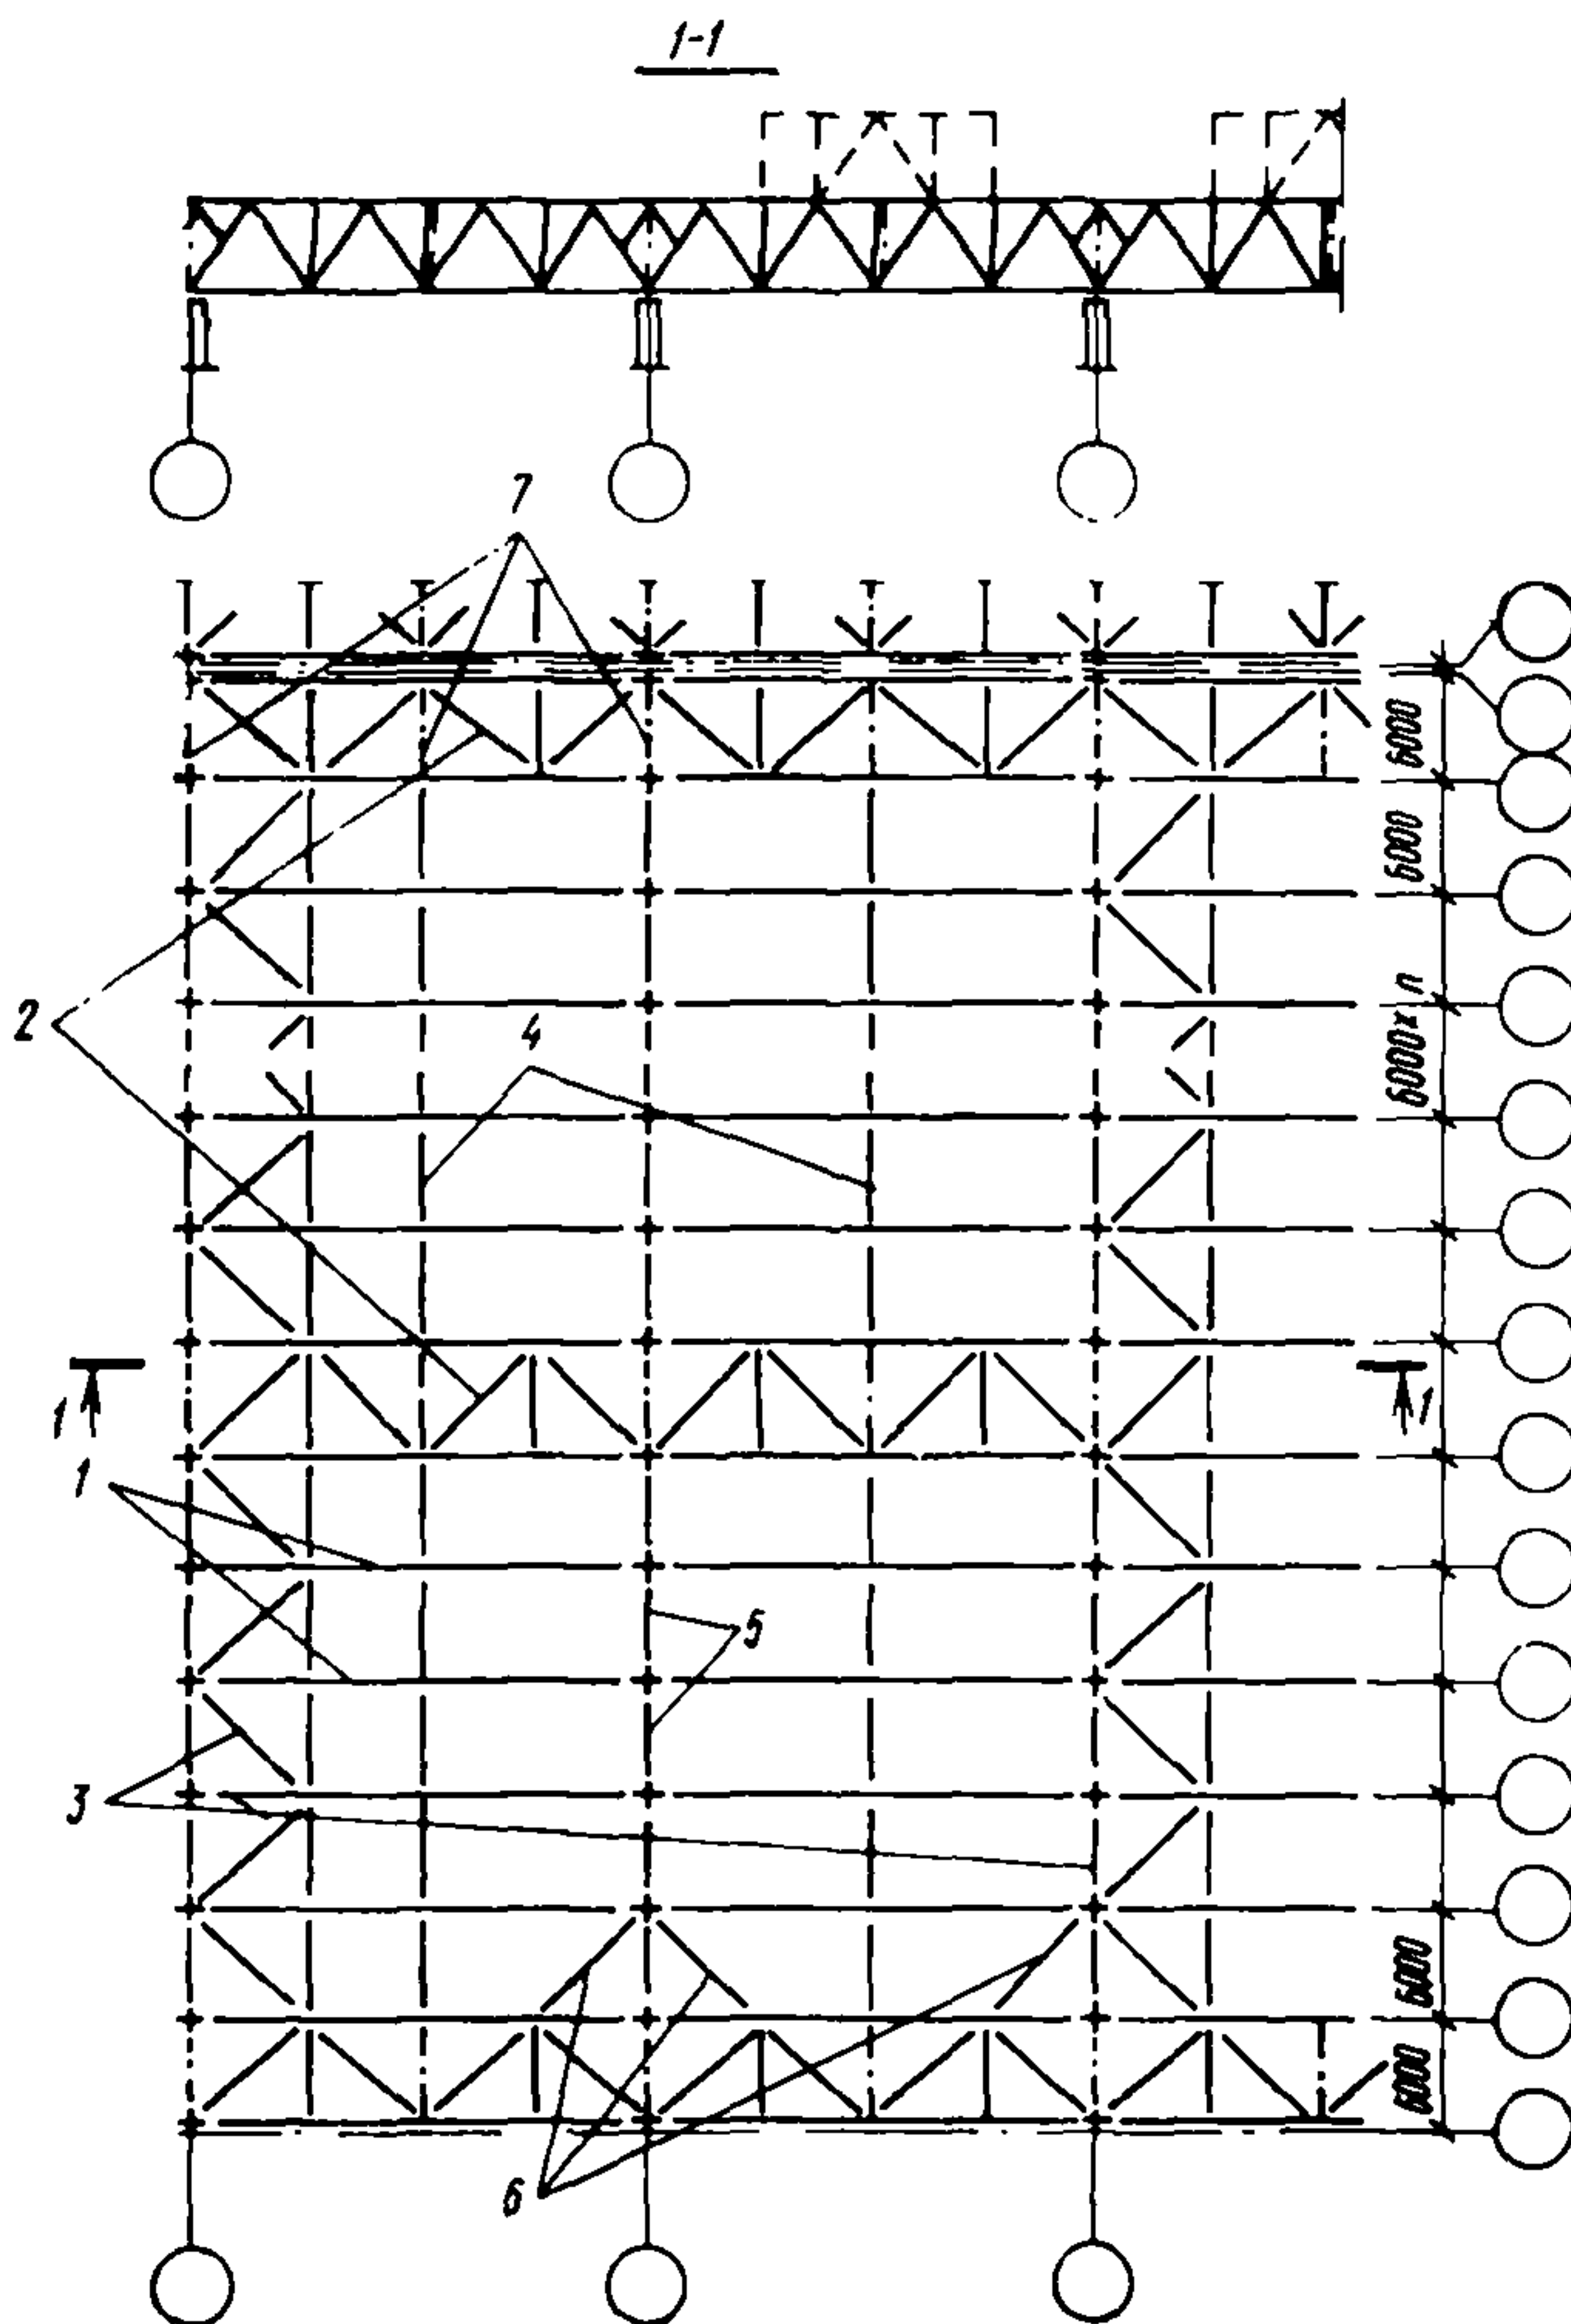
Пример расположения связей по нижним поясам стропильных ферм
